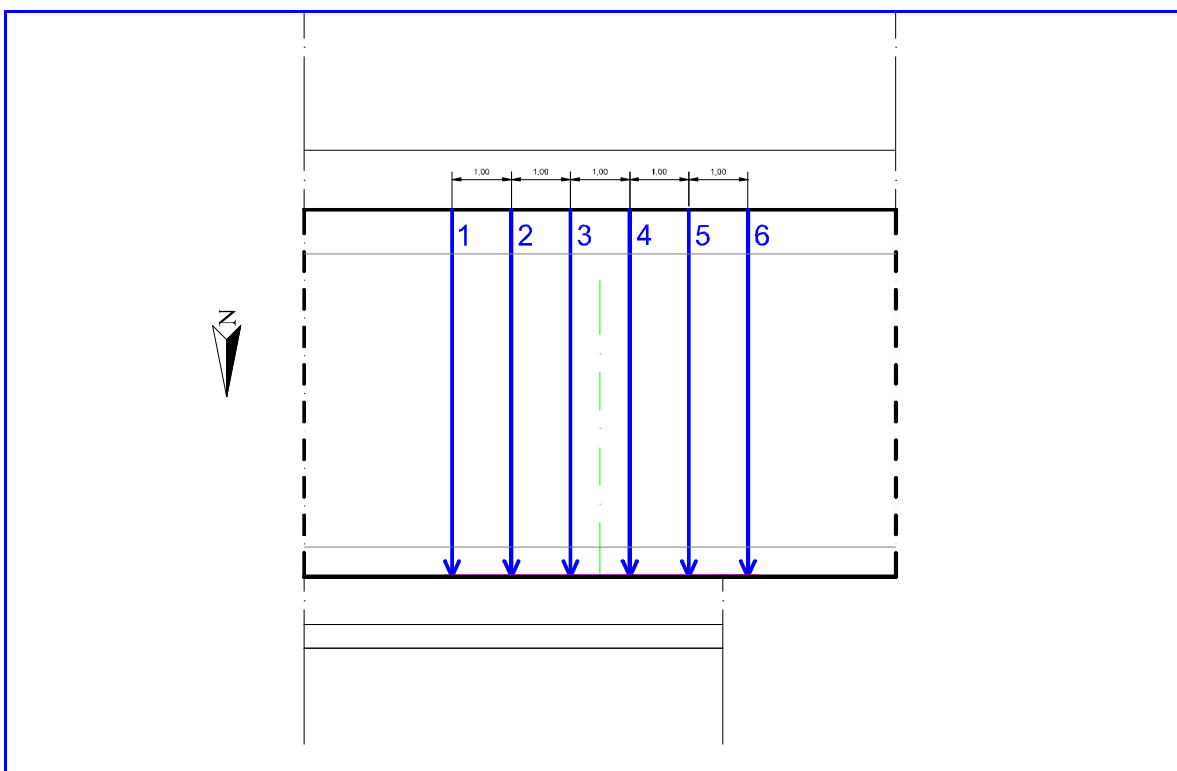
SP 34C - km 1+870 - Pianta dell'area di prova
